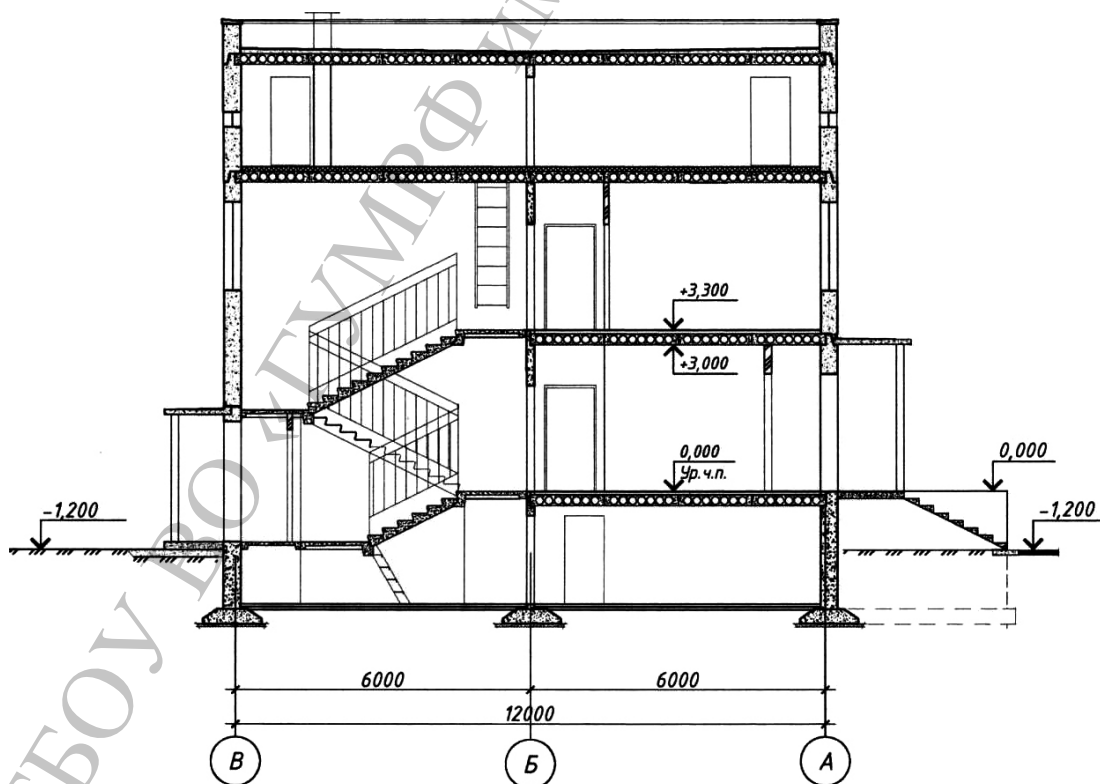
Поперечный разрез двухпролетного здания с поперечными несущими стенами
